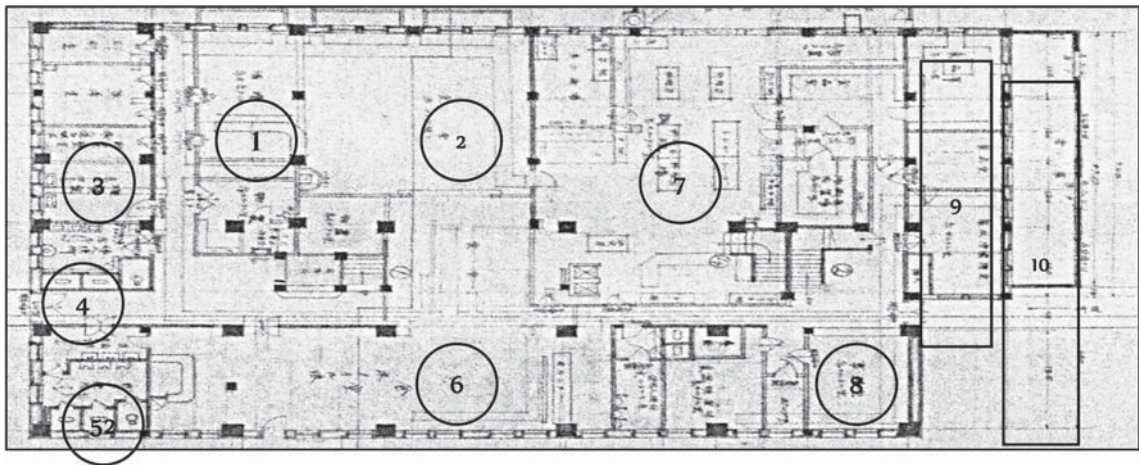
二代目「山陽ホテル」地階 平面・施設配置図
